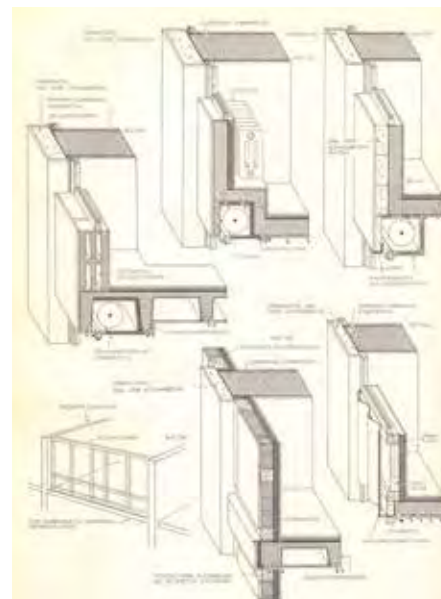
(oben): Exemplarische Außenwandkonstruktionen der Wiederaufbauzeit, Schottenbauweise mit tragenden Querwänden (Quelle: Schmitt, Hochbaukonstruktion, 1962)
